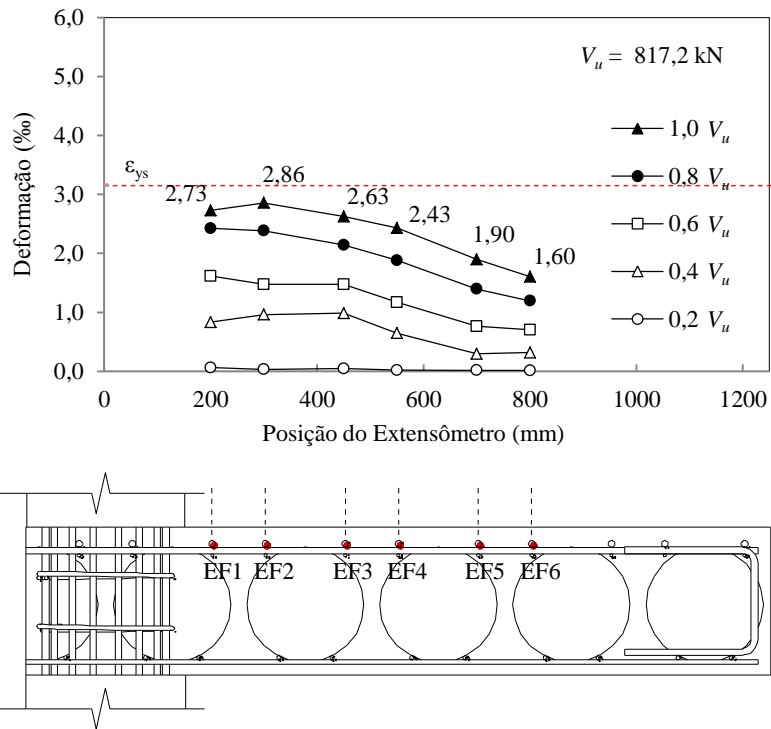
Deformações nas armaduras de flexão da laje BD1
